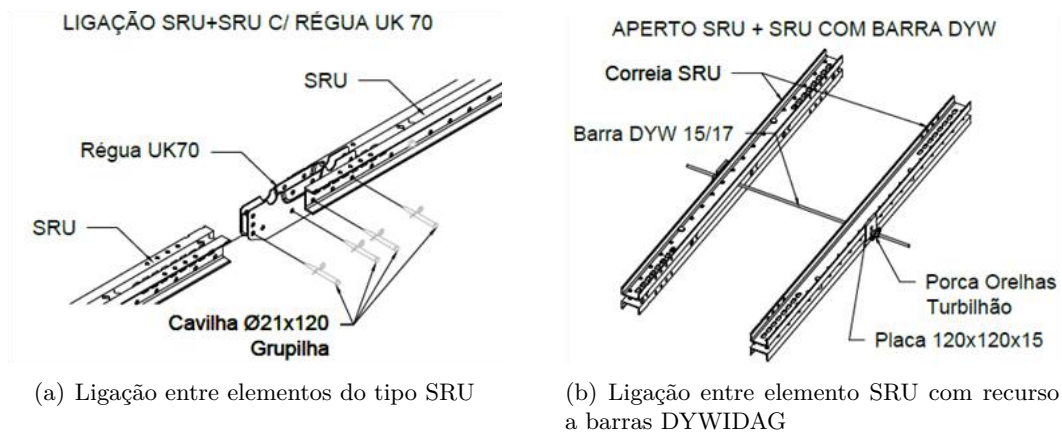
Elemento da estrutura de contenção de fachada: SRU. Retirado de [33]
